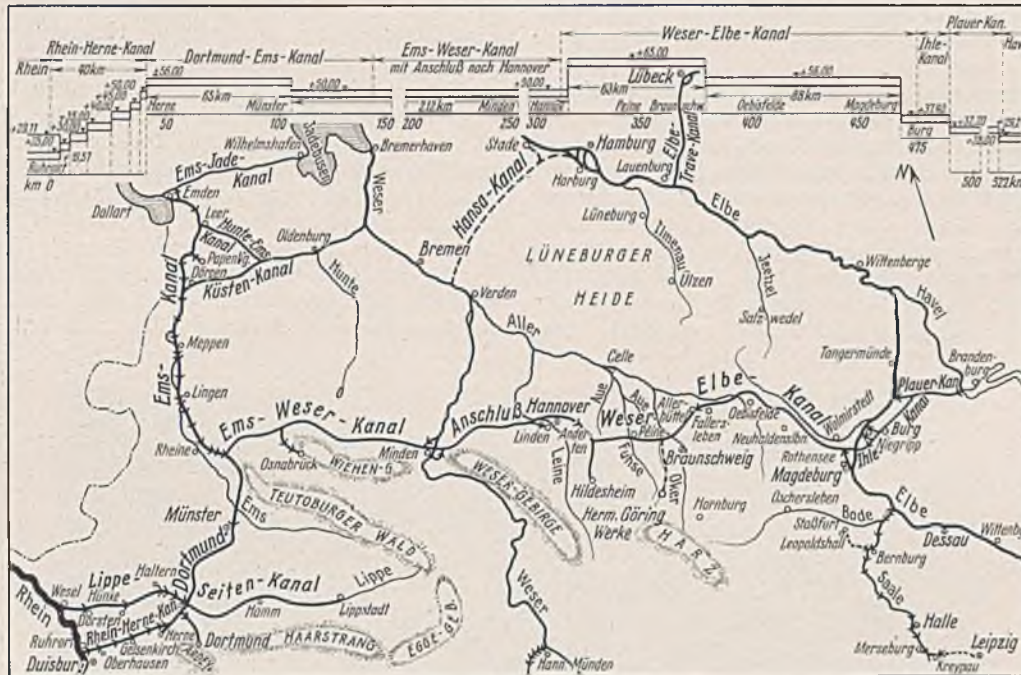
Lageplan und Längsschnitt des Mittellandkanals.
